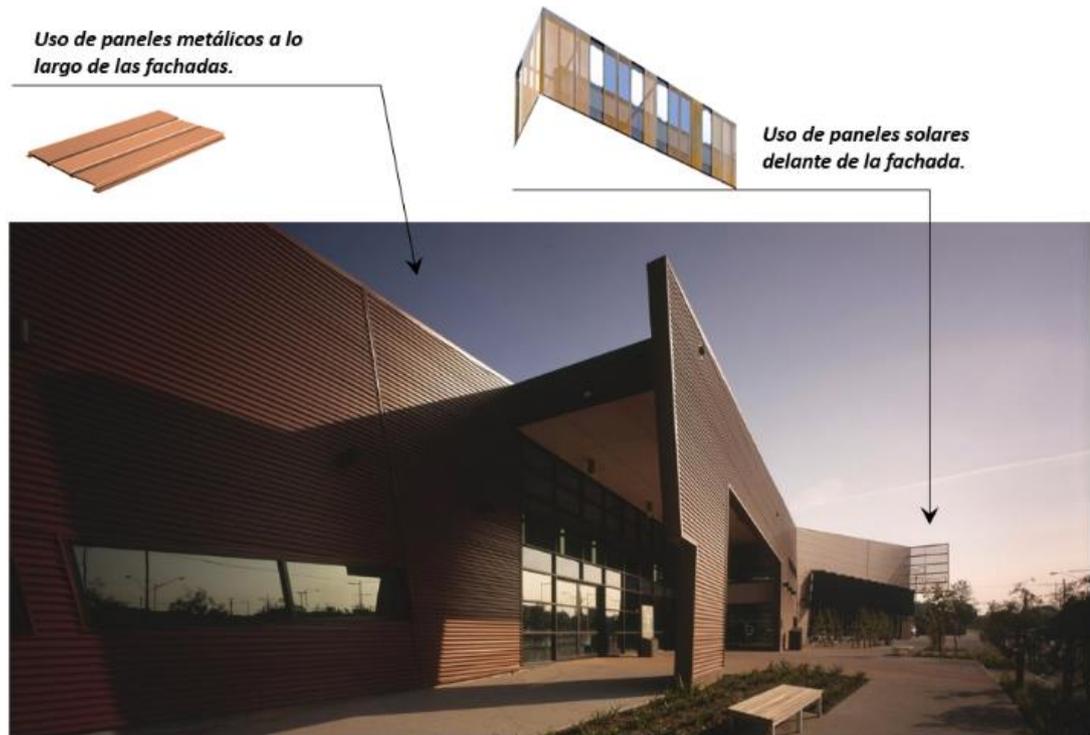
Uso de doble piel en la fachada de la infraestructura.
